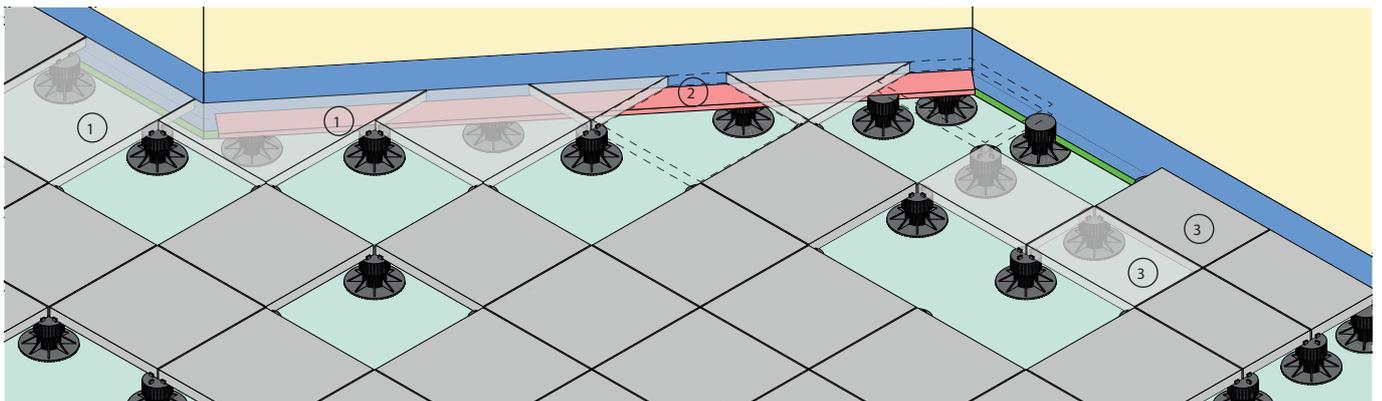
Disposition des plots sous les dalles coupées; (1) dalles coupées, variante avec un format de dalle plus grand, (2) profilé en métal, (3) raccordement réparti sur 2 ou 3 rangées de dalles de même largeur
